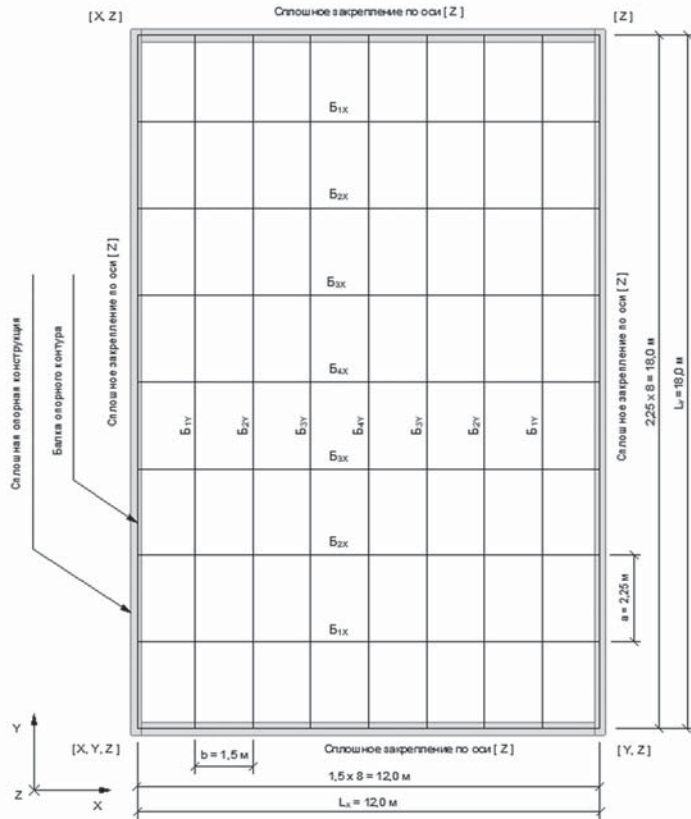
Схема кессонного перекрытия размером в плане 12,0 × 18,0 м с кессонами 1,5 × 2,25 м.
